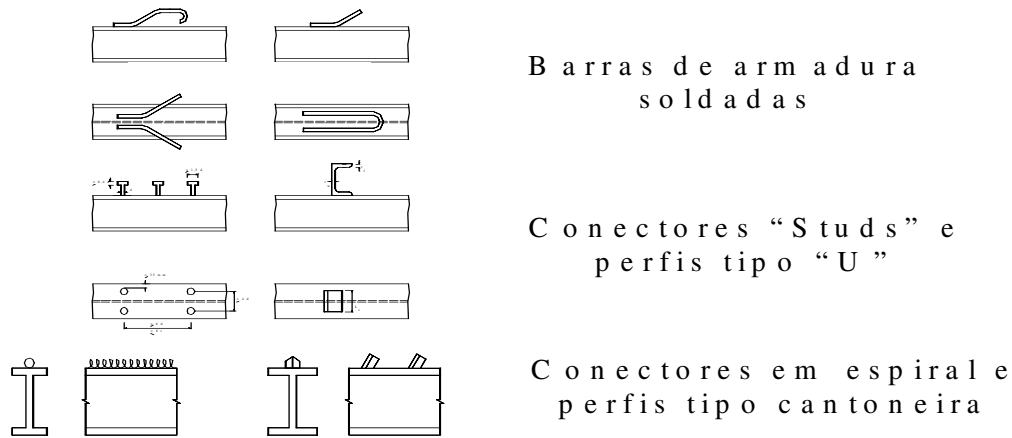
Tipos de conectores de cisalhamento em vigas mistas [4]
